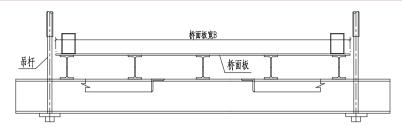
Layout of the bridge deck 图 20. 桥面板布置示意
